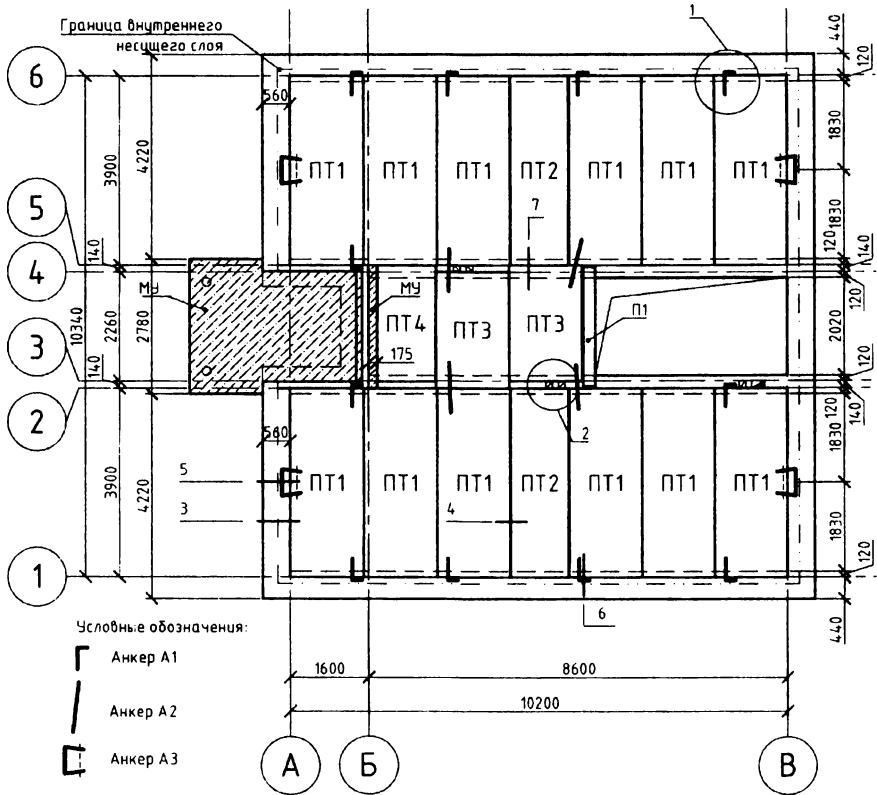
Пример выполнения плана ж.б. перекрытия (смотреть совместно с рисунком 11)
